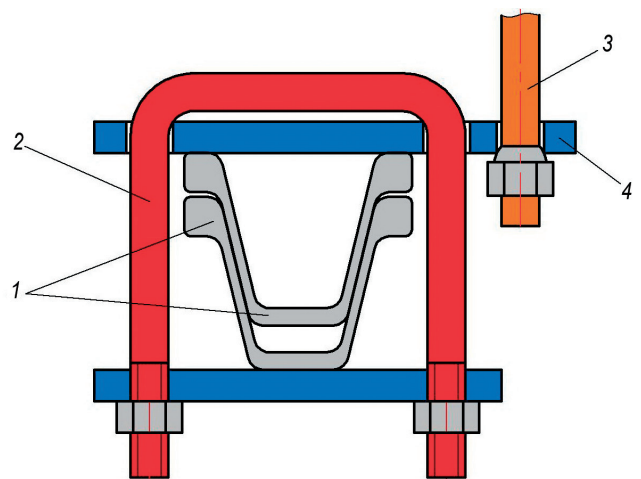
Конструкция узла соединения рамы с анкером с помощью консольной планки: 1 – рама металлокрепи; 2 – скоба; 3 – анкер; 4 – консольная планка.
